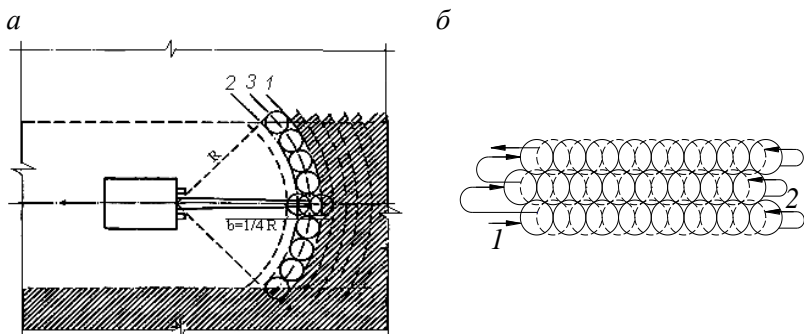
Схема уплотнения грунтовых оснований с перекрытием следов:
